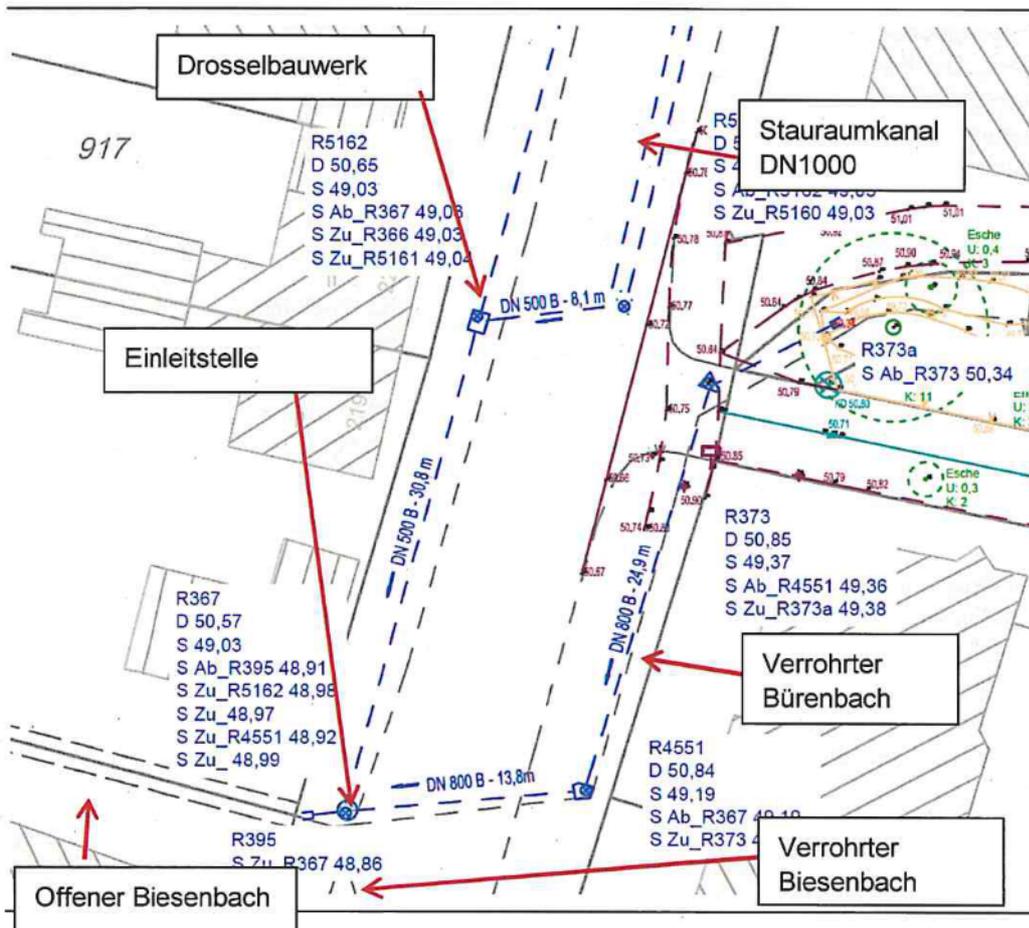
Lageplanausschnitt Einleitungsbereich (vorhandene Situation)
